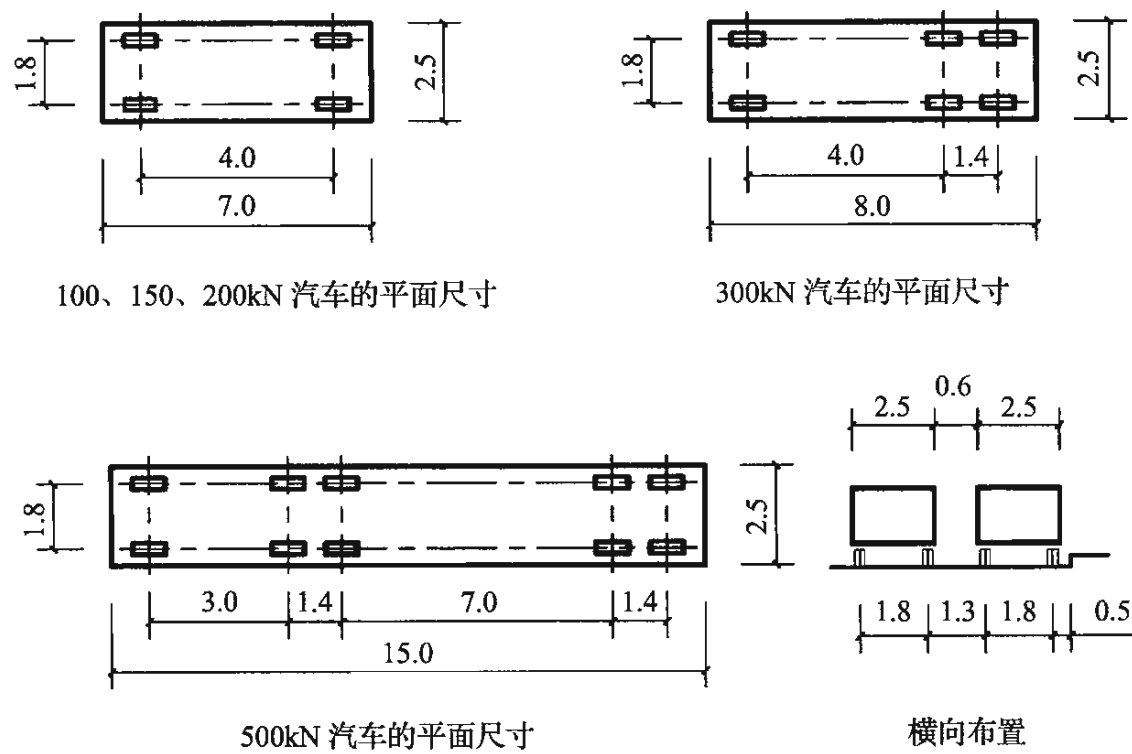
各级汽车的平面尺寸和横向布置 (单位: m)
